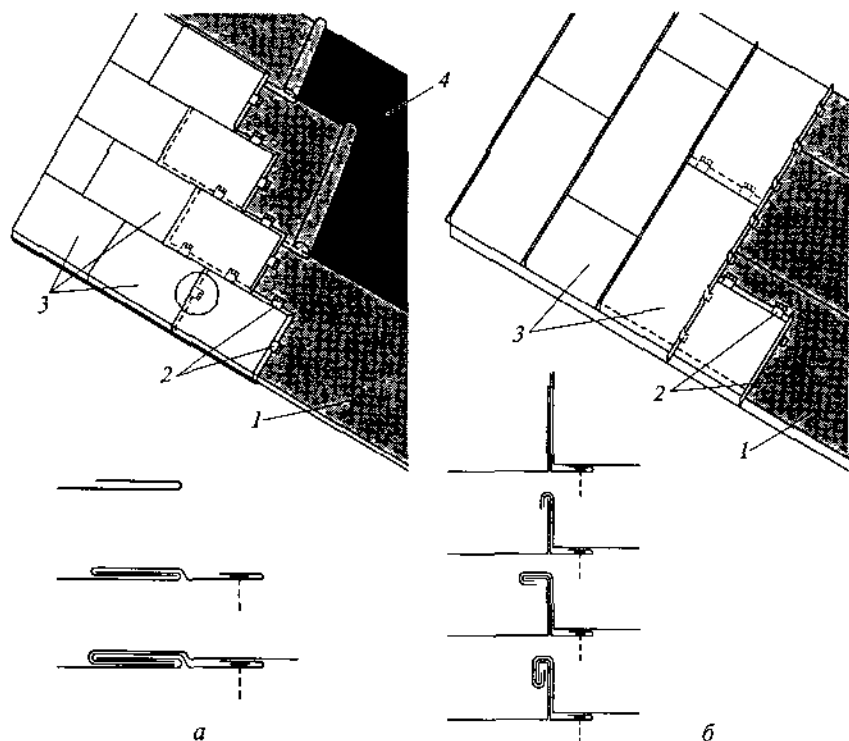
Укладка стальных листов (картин) с соединением фальцами: а — лежачими; б — стоячими; 1 — рулонный гидроизоляционный материал; 2 — кляммеры; 3 — стальные листы; 4 — мастика
